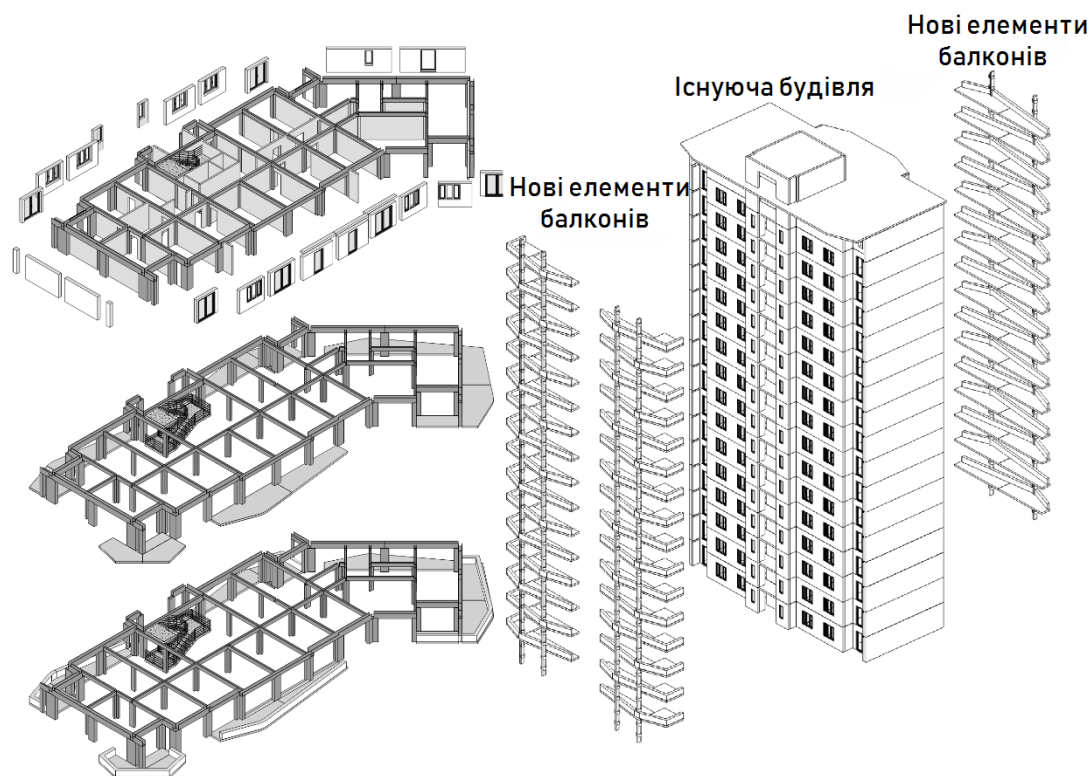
Будівельна система [2], що передбачає модульні конструктивні елементи для реконструкції 16-поверхового житлового будинку
